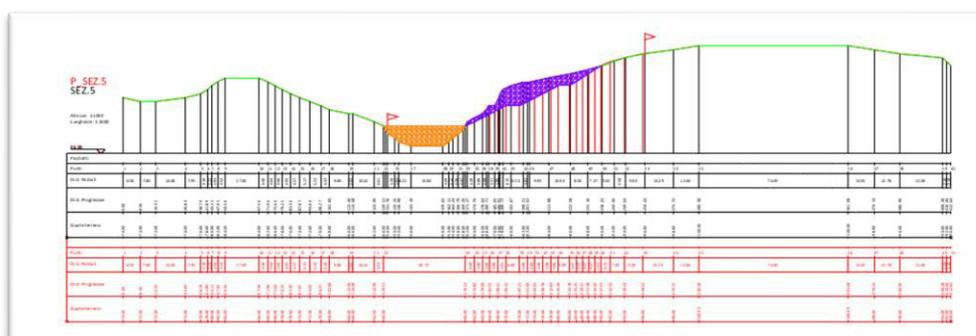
Rappresentazione esemplificativa delle sezioni di progetto allo stadio finale
